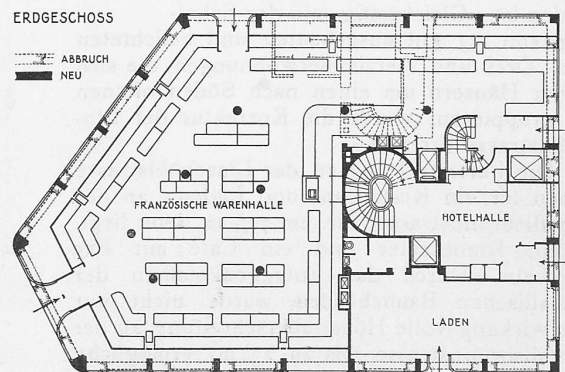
bis 3. Grundrisse des Geschäftshaus-Umbaues zum „Touring-Hotel“ in Zürich. — Masstab 1 : 400.
